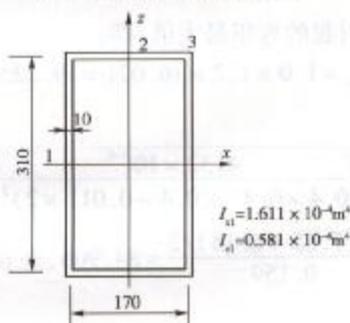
最大剪应力的位置(尺寸单位:mm)
